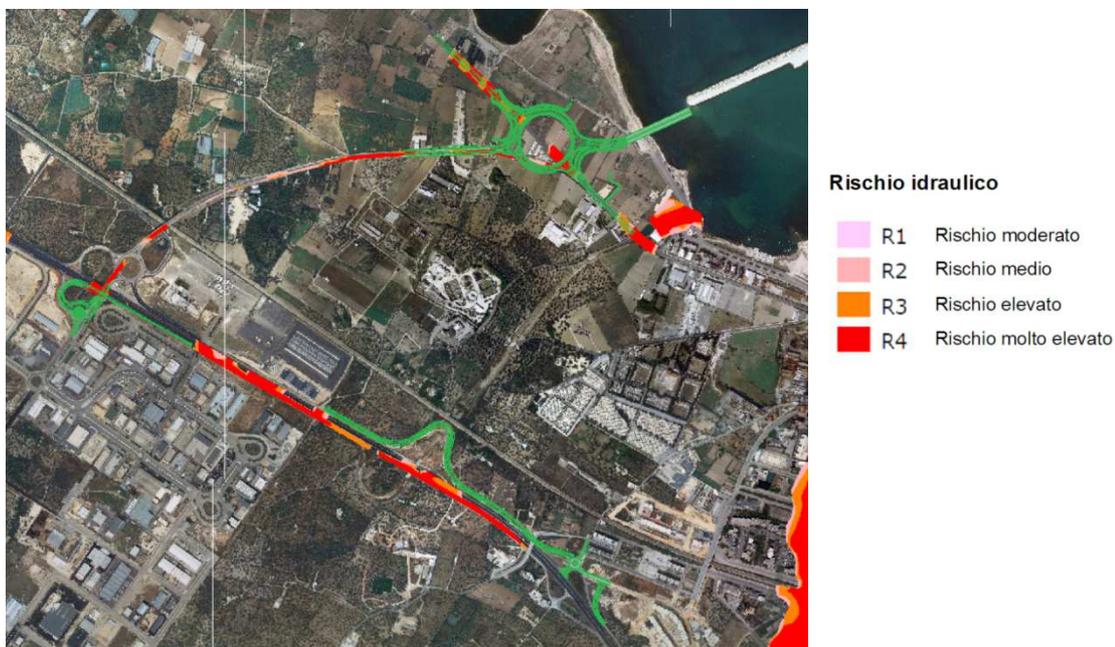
Stralcio planimetria di sovrapposizione PAI (Rischio idraulico)
